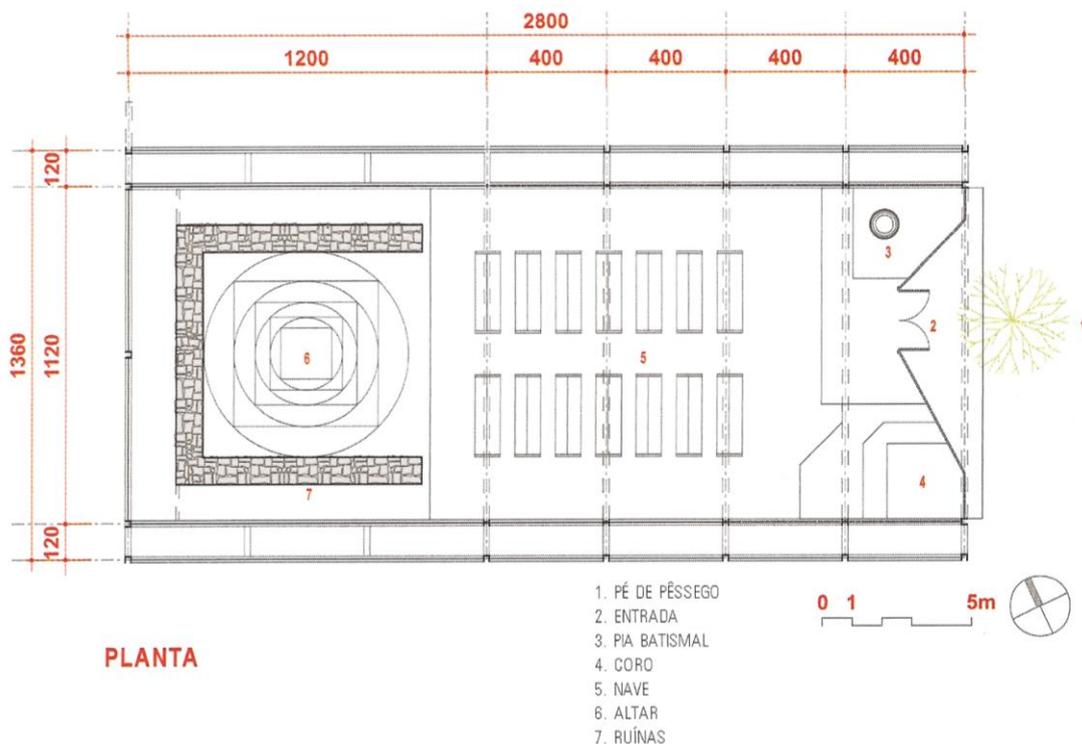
Planta da Capela de Santana do Pé do Morro.
